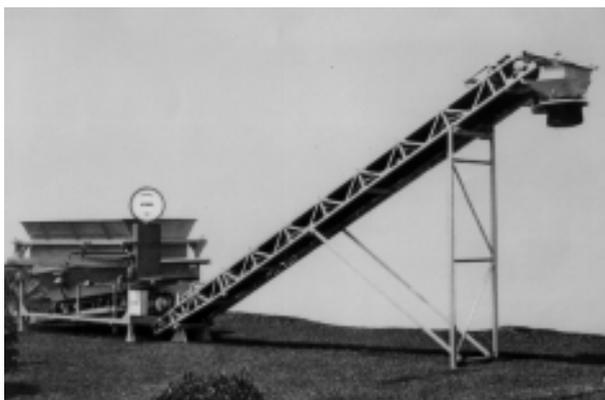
Concreto pré-misturado fora da obra (cortesia ABESC)
